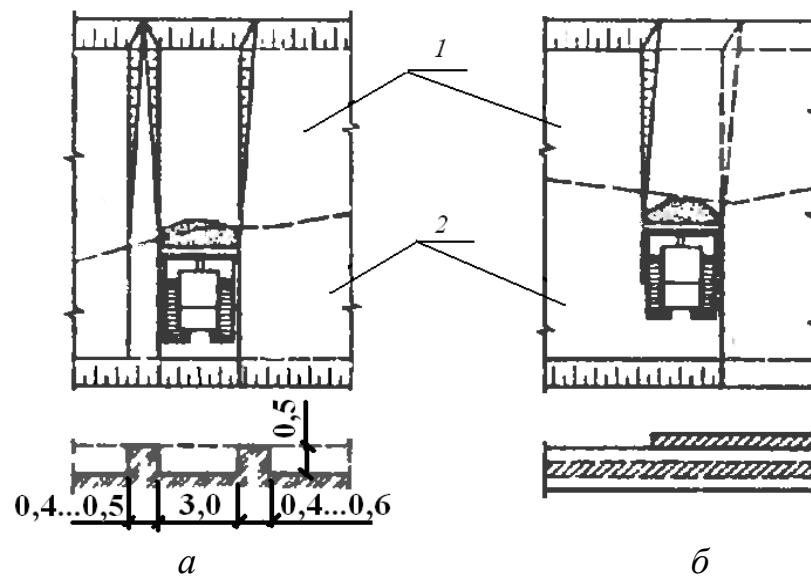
Схемы резания и перемещения грунта бульдозером: *а* – траншейный; *б* – послойный; 1 – насыпь; 2 – выемка
